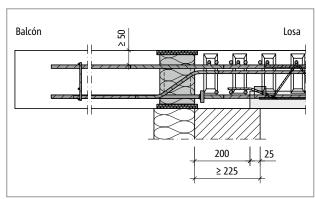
Schöck Isokorb® XT tipo C: Placa prefabricada sin apoyo periférico con SATE (sección XT tipo C-R-CV50, vista XT tipo C-L-CV35)
